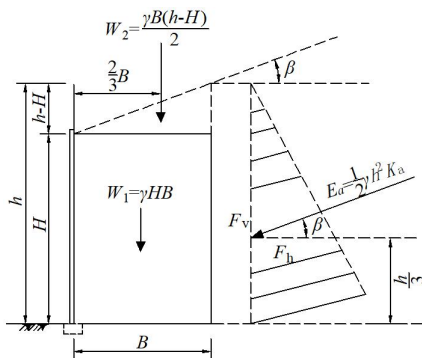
墙背垂直、填土面倾斜时的土压力计算
